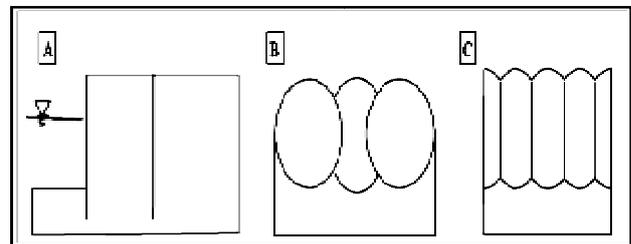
Coupe d'un gabion (A), vue en plan d'une gabionnade avec arcs de raccordement (B)
